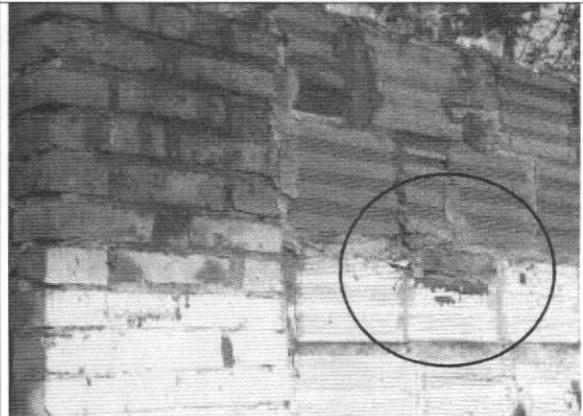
Bloques de arcilla en regular estado, muro costado norte
